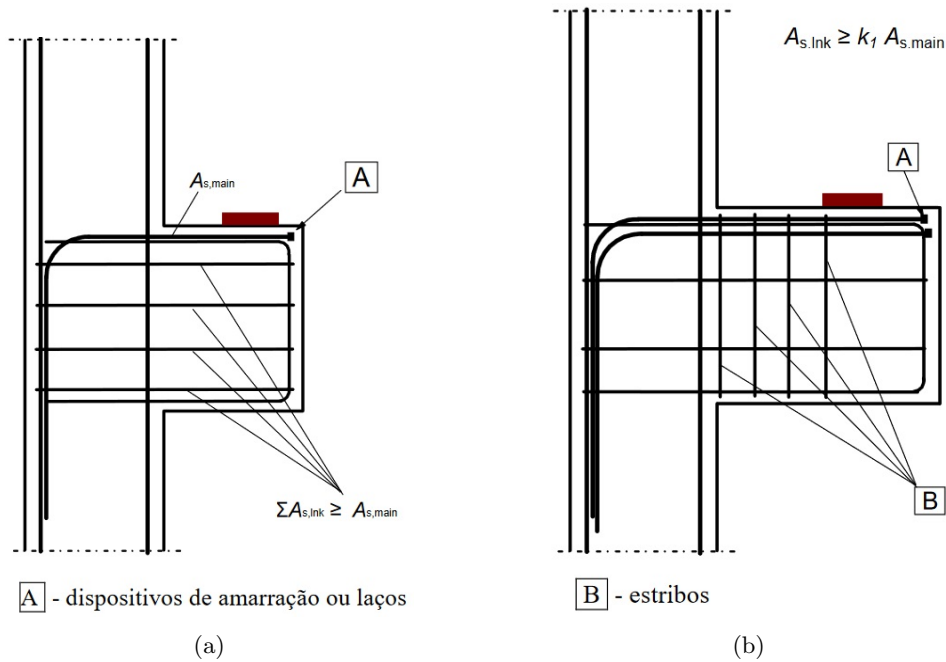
Detalhamento das armaduras de consolas curtas, segundo o Standardization [1]: (a) Armaduras para $a_c \leq 0,5h_c$; (b) Armaduras para $a_c > 0,5h_c$, adaptado de Standardization [1]
